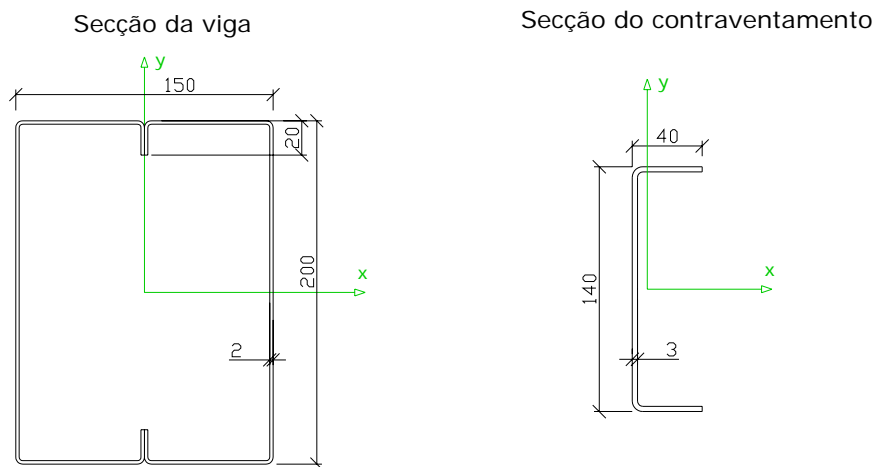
Secção das vigas e contraventamentos da solução original
